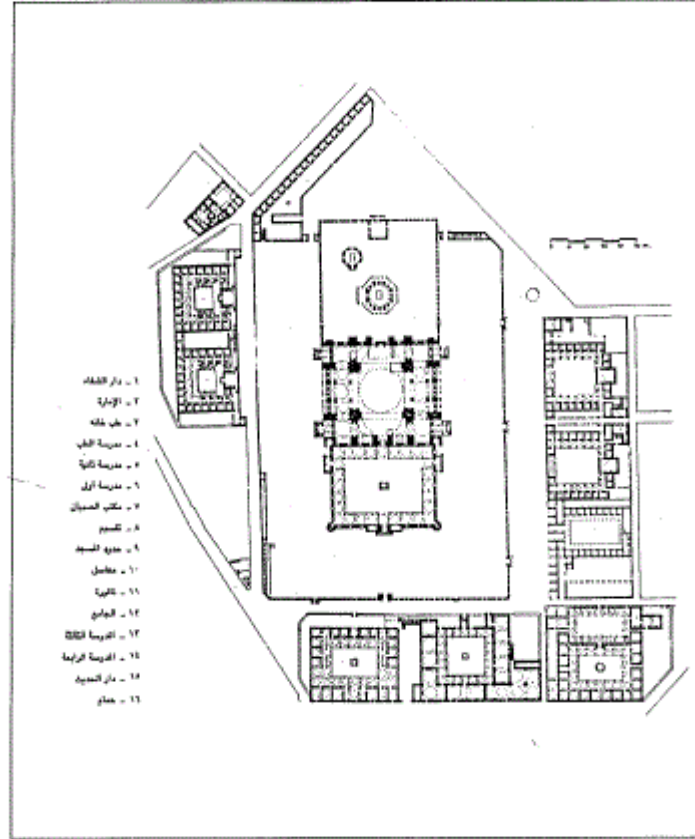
مسقط أفقي لمجمع السلطان الفاتح في إستانبول (عن: أرسبكا) .
